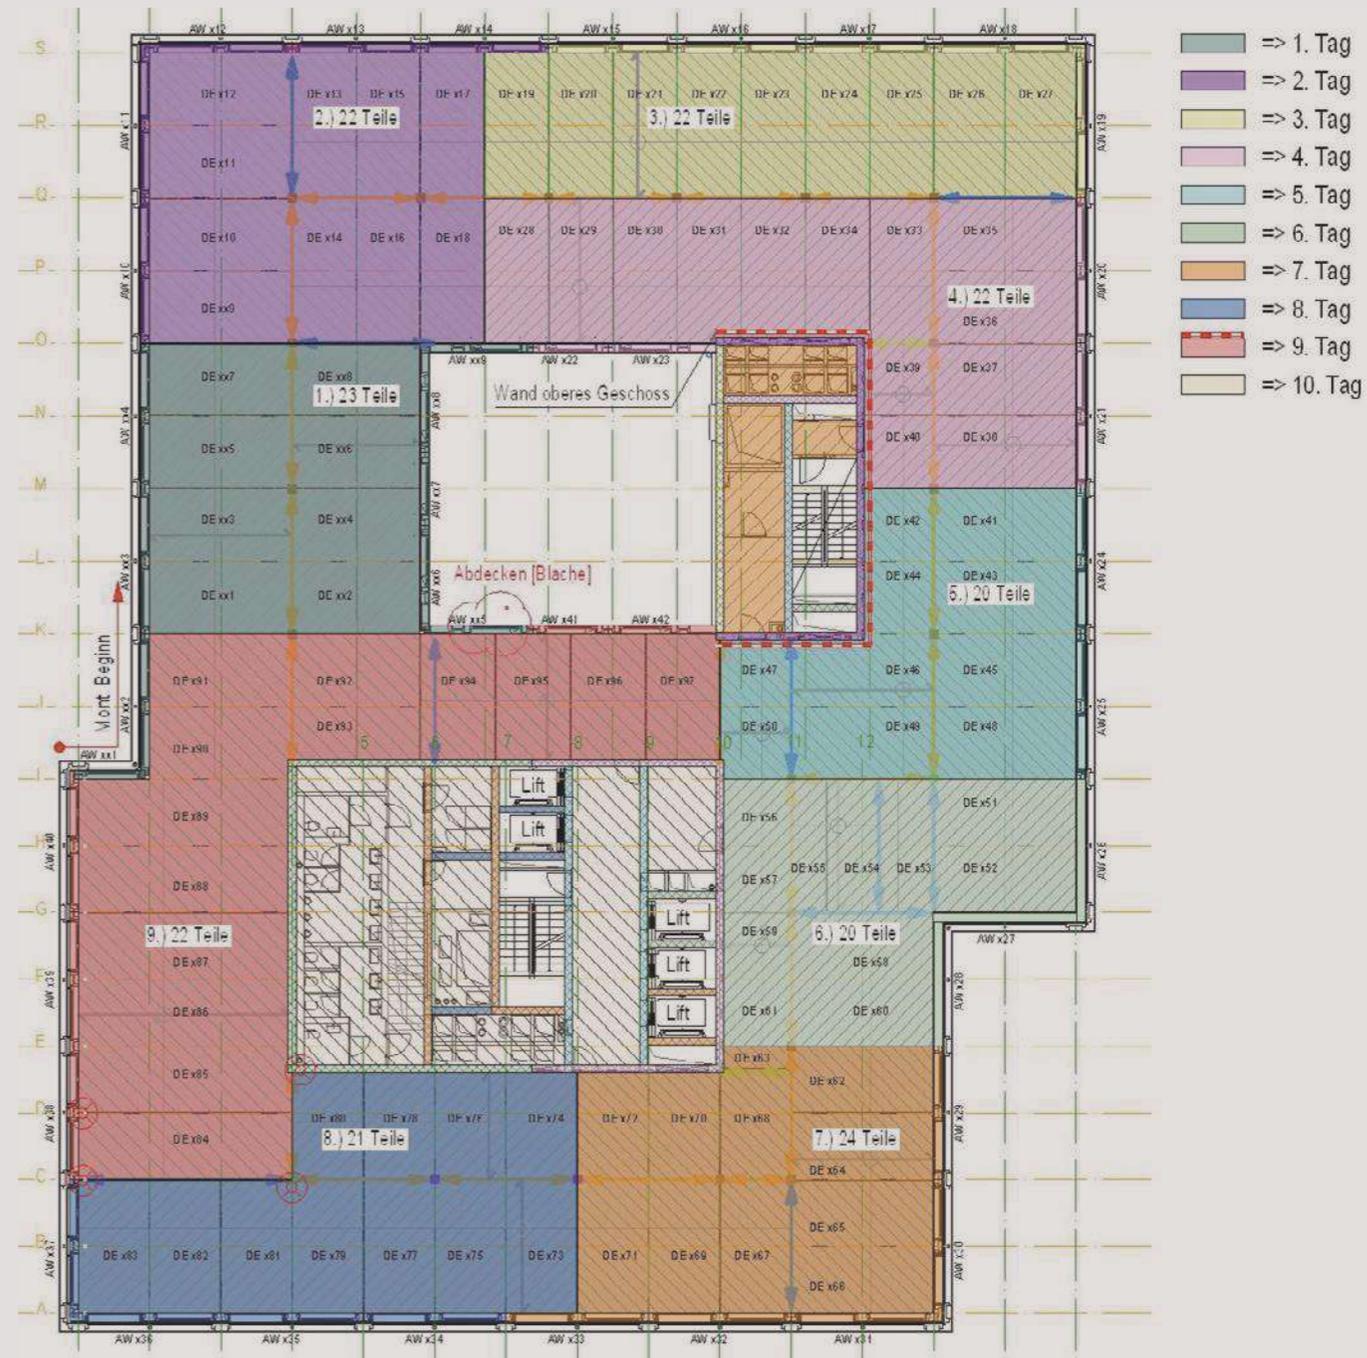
Bauzeitplan eines Geschosses M 1:300
